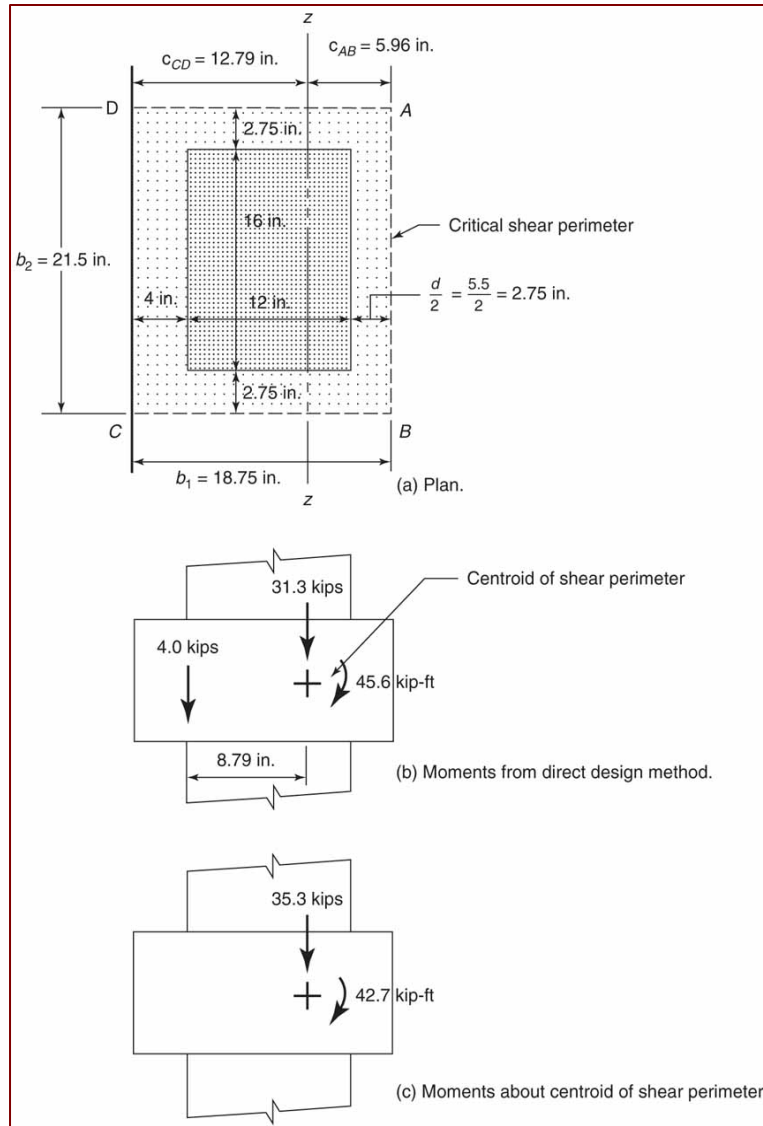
Junta de unión losa-columna para el Ejemplo 10-13.
